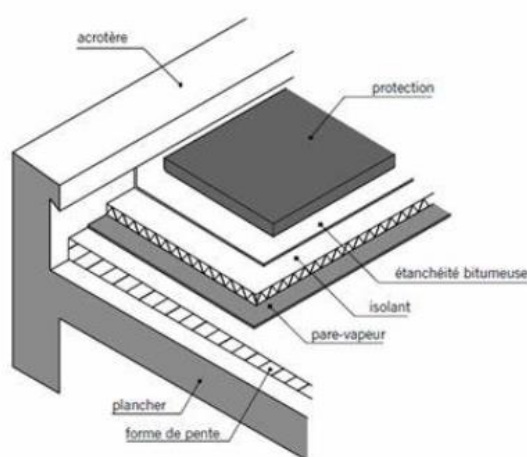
Coupe transversale d'un plancher terrasse inaccessible.
